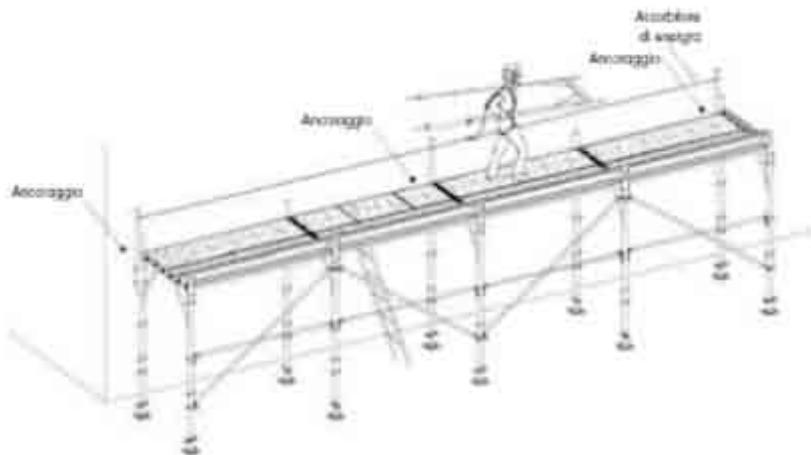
Fase operativa di montaggio del secondo livello: linea di ancoraggio posta ad un livello più elevato rispetto al piano di lavoro.
